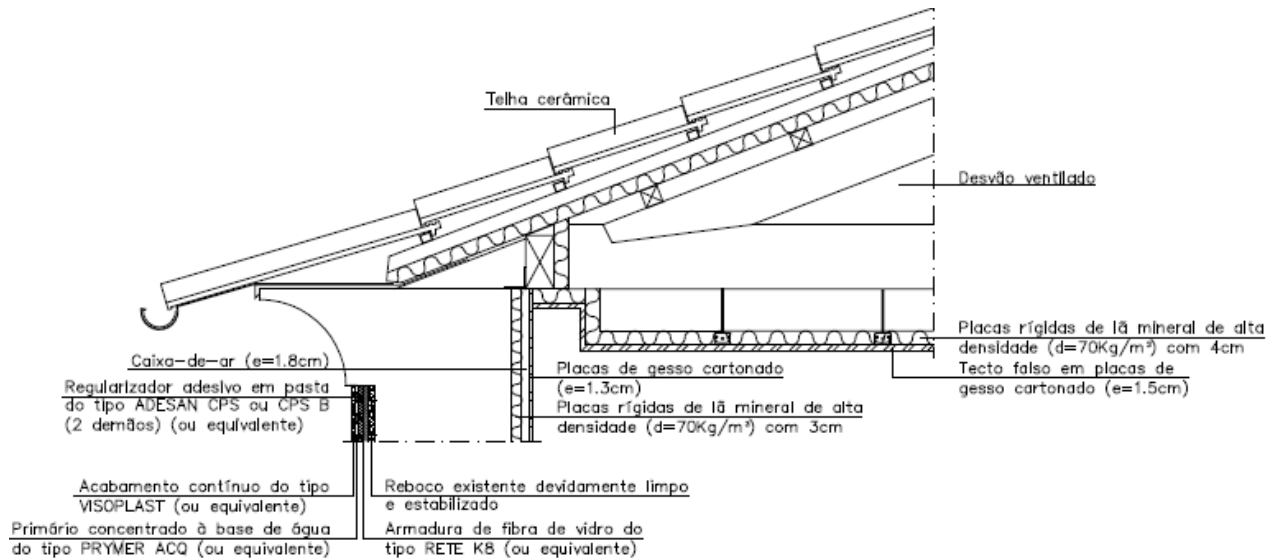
Pormenor de ligação entre a parede de fachada e cobertura (Projeto de CT)
